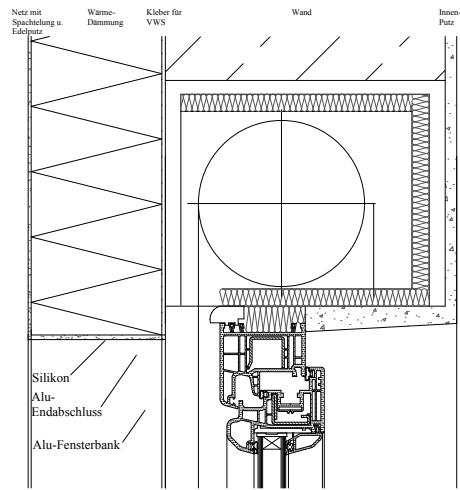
Fensterdetail Anschluss oben: M 1: 10
